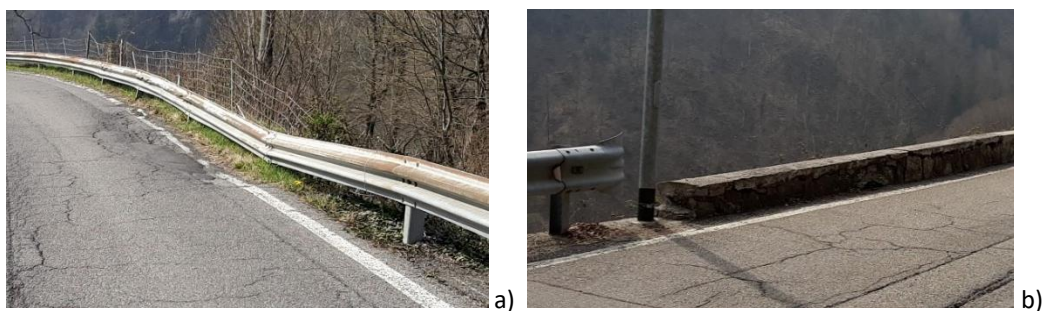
Altezza estradosso nastro non adeguata in seguito a: a) cedimento muro di sostegno b) scorretta manutenzione stradale
